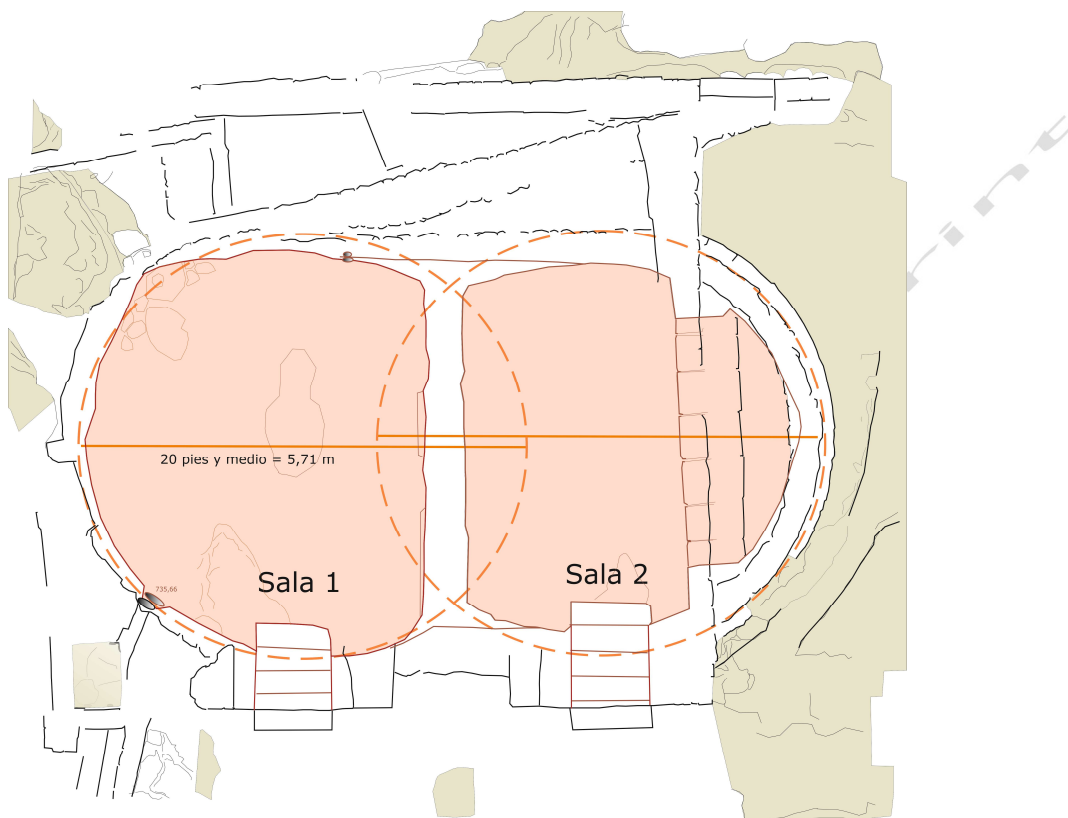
Planta de los baños con la geometría utilizada en su construcción.
